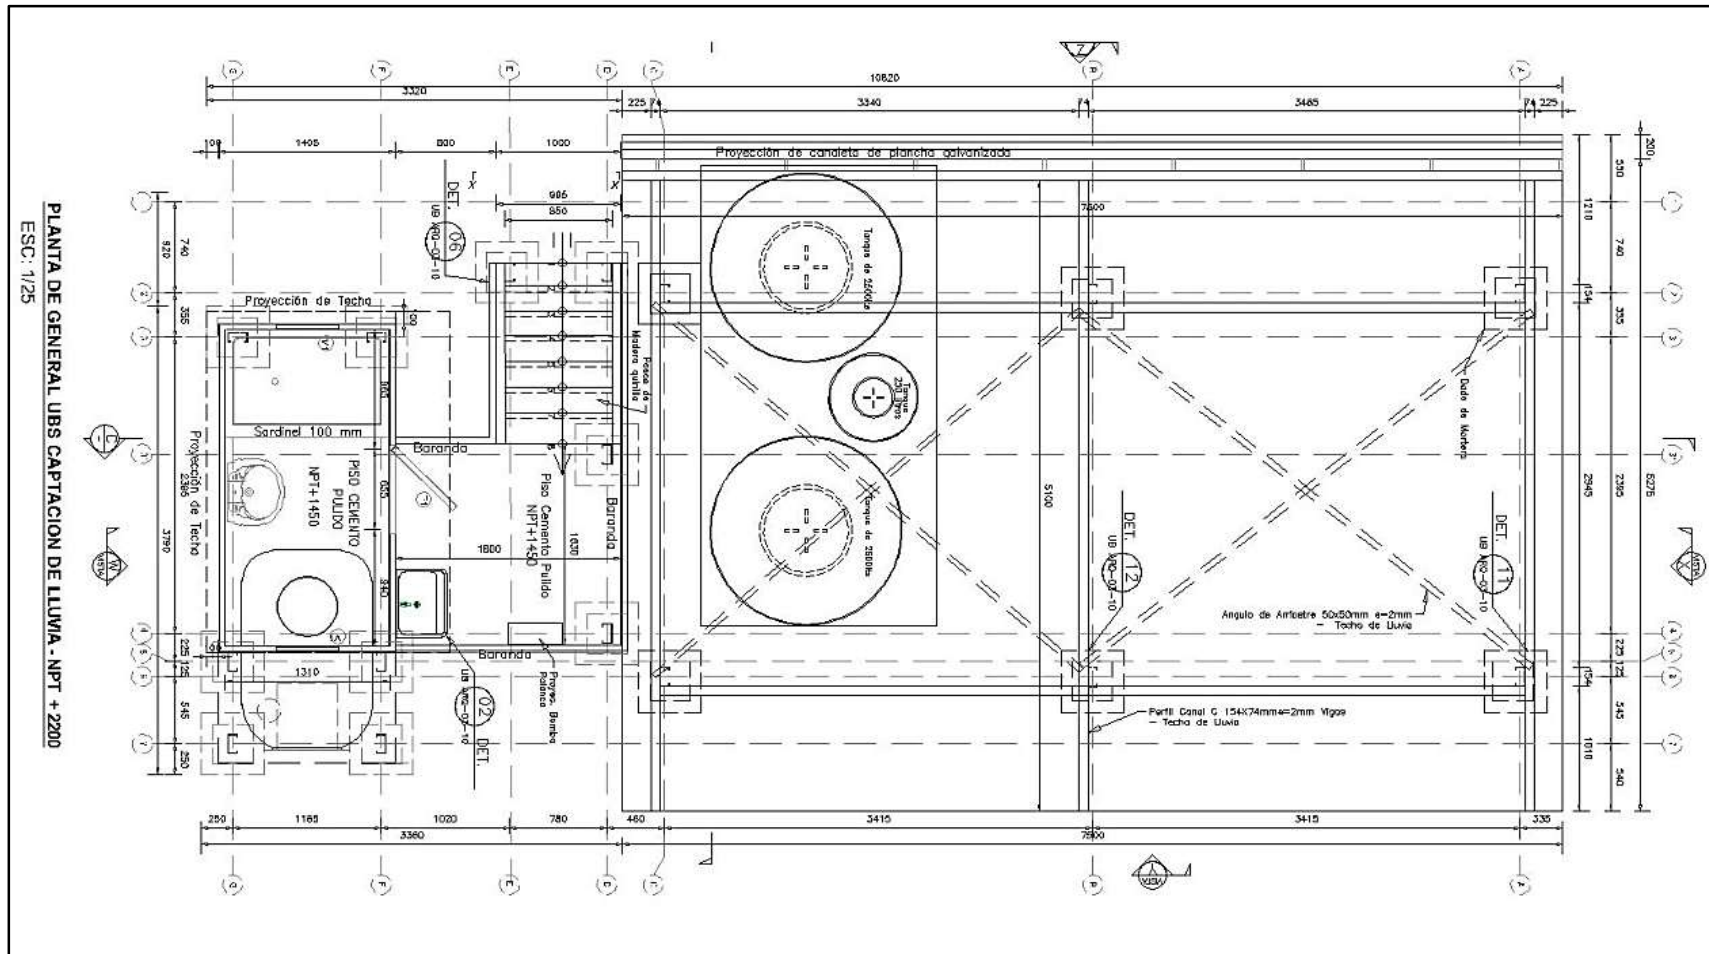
plano de planta del módulo domiciliario UBS mediante el sistema Steel Framing
